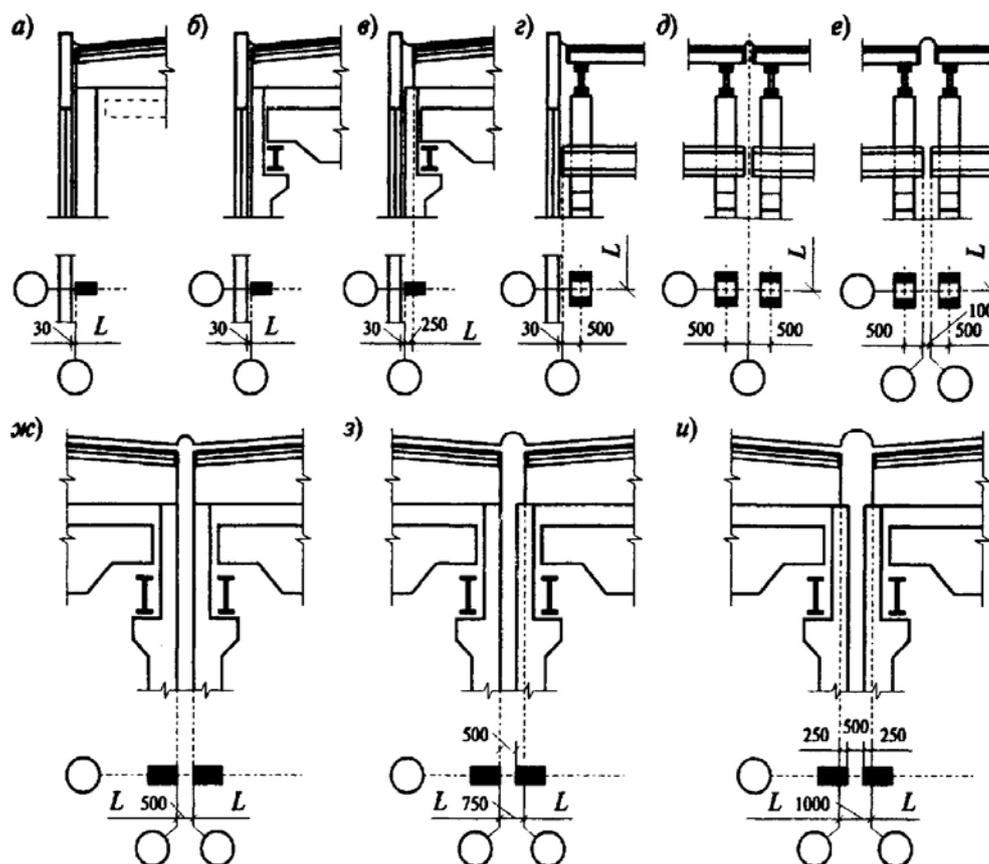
Привязка элементов одноэтажных зданий к продольным и поперечным разбивочным осям: а, б – нулевая привязка колонн и наружных стен к продольным разбивочным осям; в – то же, привязка «250»; г – привязка к поперечным разбивочным осям в торцах зданий; д, е – то же, в местах поперечных температурных швов; ж-и – привязка колонн и вставки между продольными осями в местах продольных температурных швов в зданиях с пролетами одинаковой высоты
